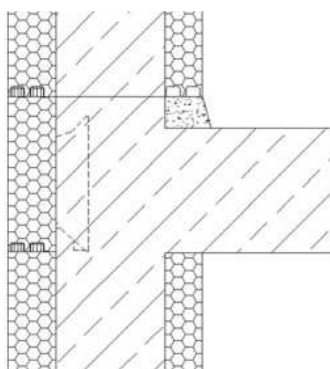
Parede e laje com camada de compensação na face interior da parede (ARGISOL, 2010).
